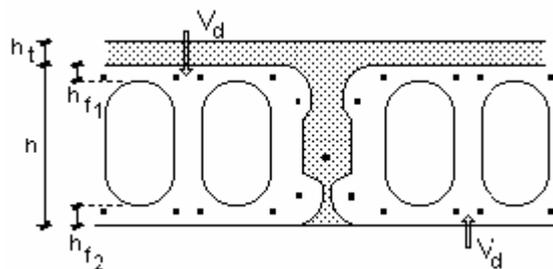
d Esfuerzo cortante en las juntas entre losas alveolares
